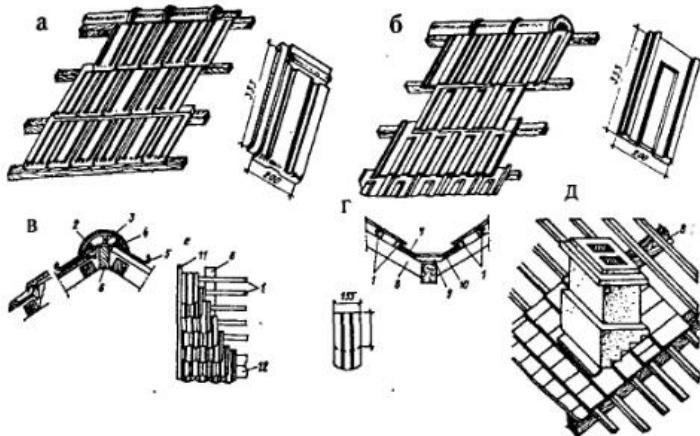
Детали черепичных кровель: а — кровля из пазовой штампованной черепицы; б — из пазовой ленточной черепицы; в — деталь конька; г — деталь разжелобка; д — деталь отделки дымовой трубы черепицей; е — двухслойная кровля из плоской ленточной черепицы. 1 — обрешетка; 2 — коньковая черепица; 3 — проволока; 4 — раствор; 5 — крюк для стремянки; 6 — подкладка под крюк; 7 — доска толщиной 25 мм; 8 — стропильная нога; 9 — доска толщиной 40 мм; 10 — кровельная сталь; 11 — ветровая доска; 12 — карнизная доска.
